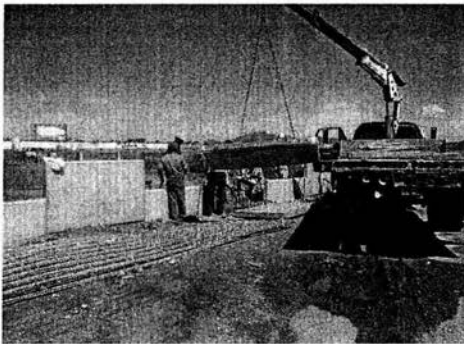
Colocación de escamas en el muro del estribo 4
